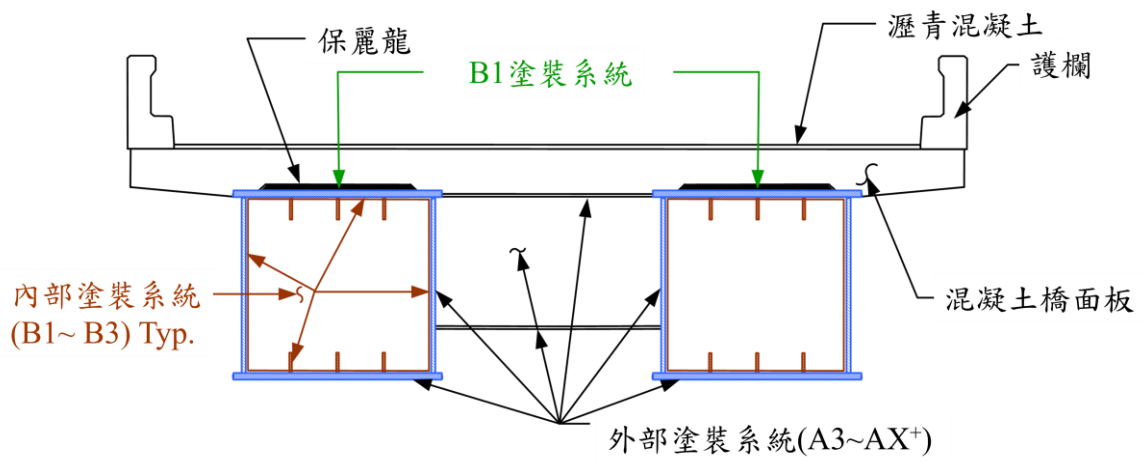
含混凝土橋面板之鋼橋塗裝示意圖^[6]
